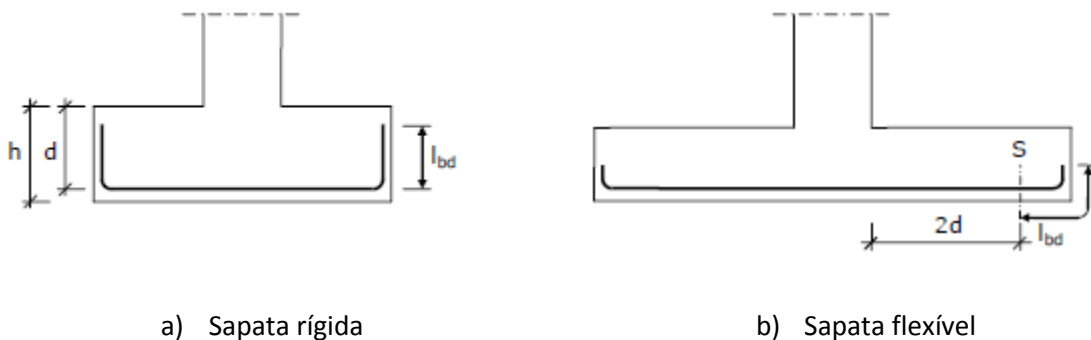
Amarracao da armadura principal em sapatas. [8]
